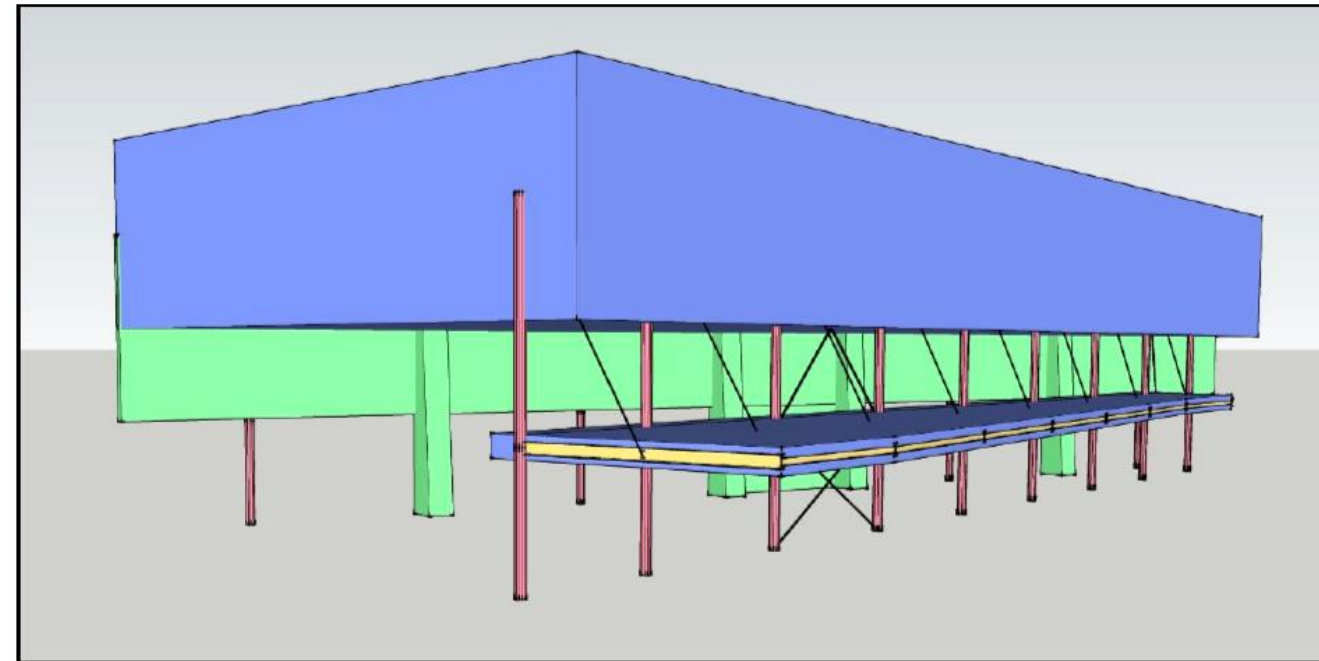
Principe d'ancrage du bâtiment sur micropieux (AREP)
